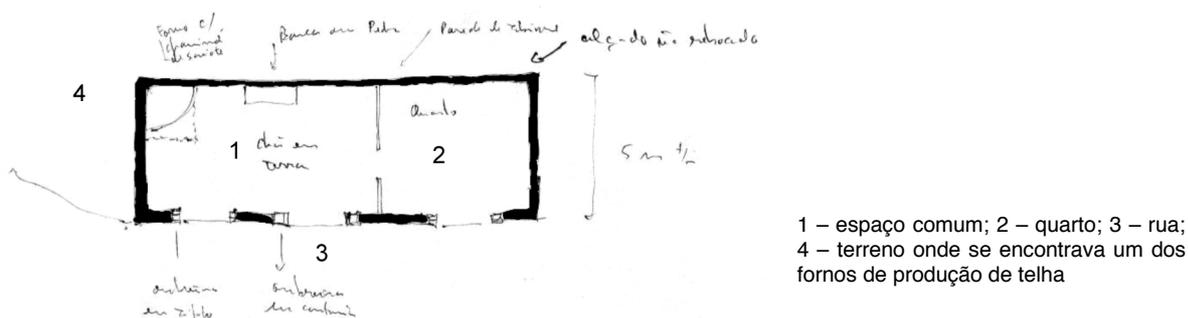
Planta esquiciada da Casa Elementar Composta de Telheiro TL4
